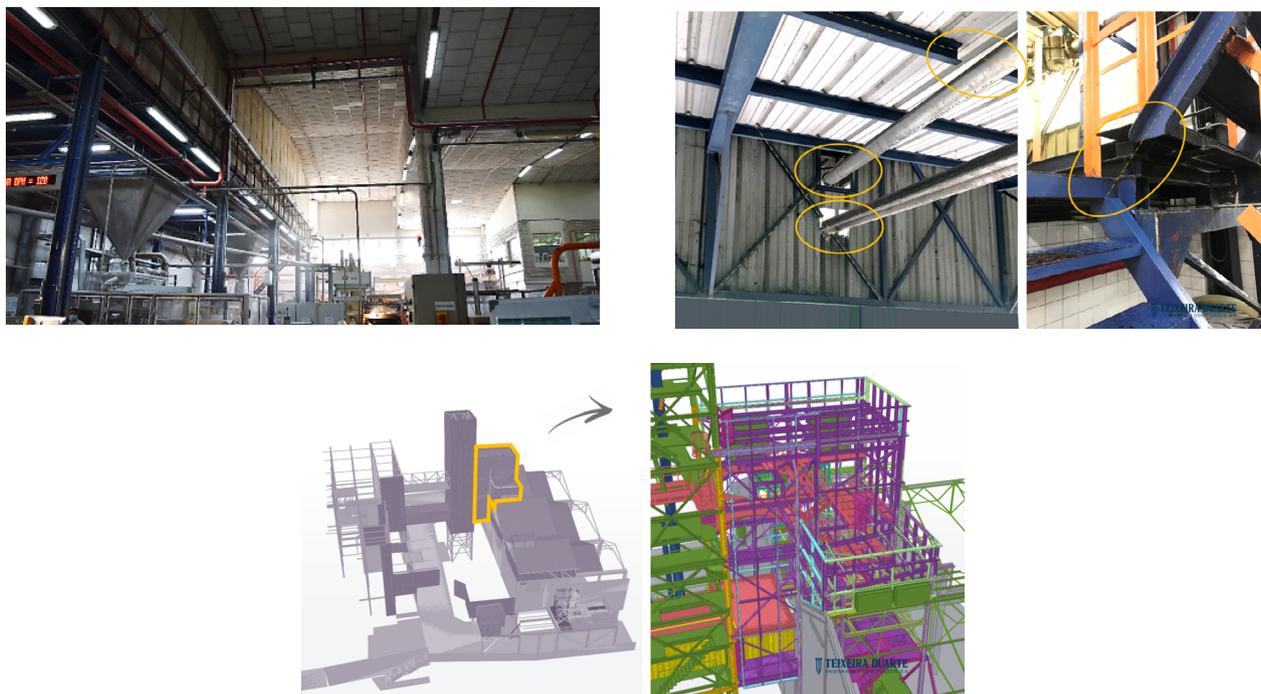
Aspeto das instalações fabris intervencionadas; Exemplo de intervenções anteriores que danificaram a integridade estrutural das instalações; Estruturas metálicas dimensionadas;
